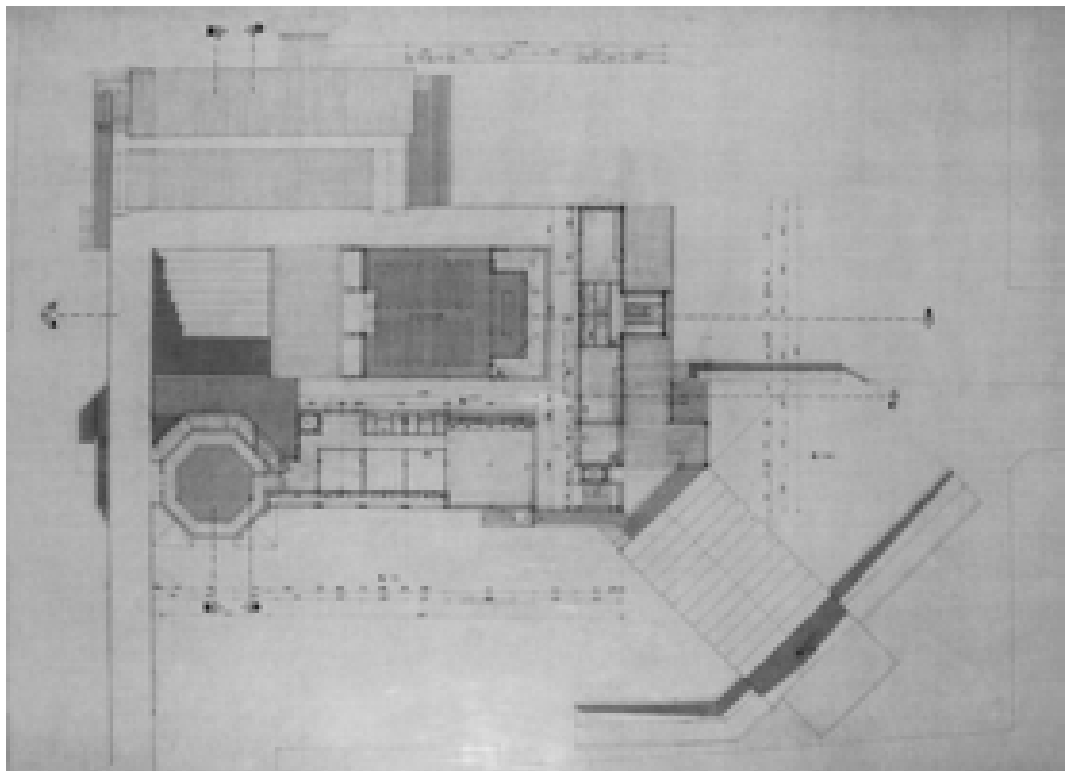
Pianta +4,00, stato futuro - 1989 (AABS-64_496)
